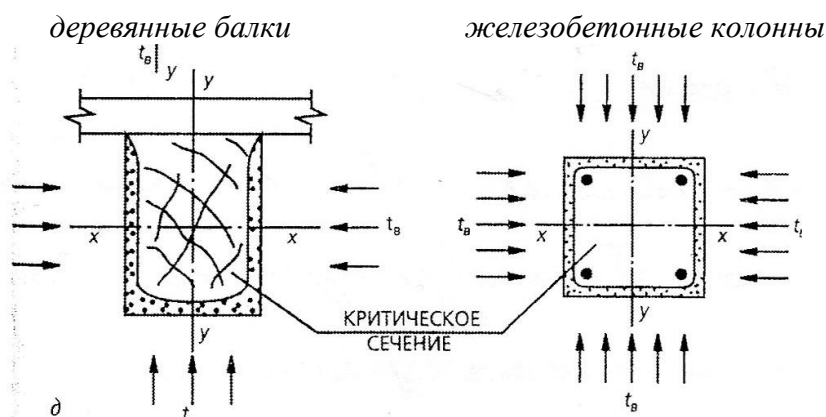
Расчетная схема 3 - по определению предела огнестойкости деревянной балки и железобетонной колонны
